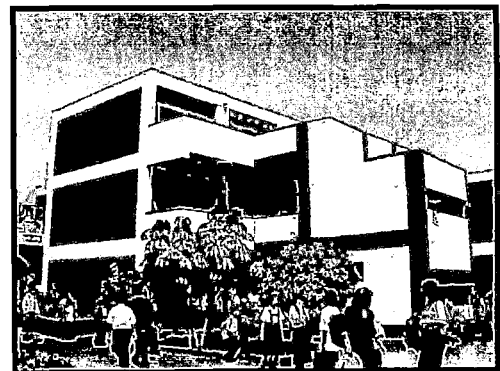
EPM Rosa Merino, estructuración tipo I
